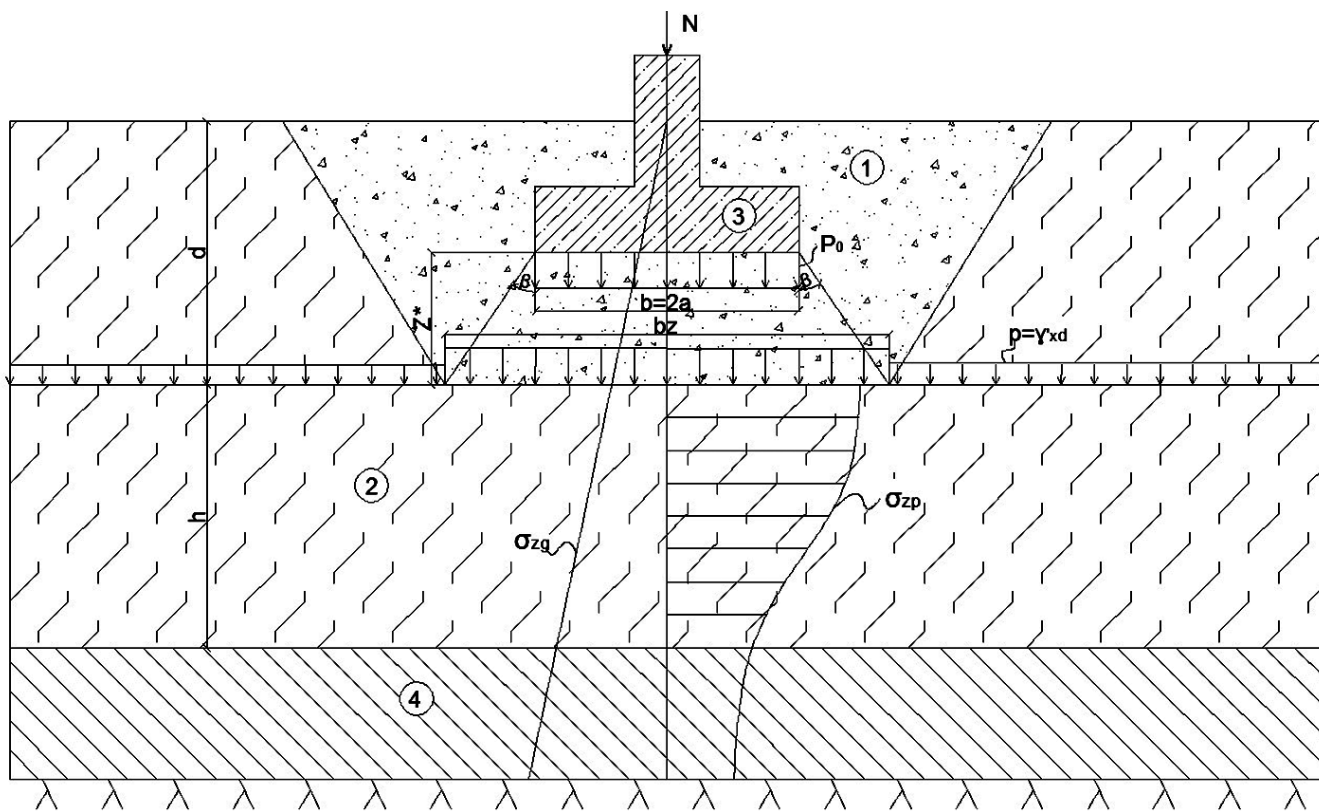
Расчетная схема грунтовой подушки (1) на слабом основании (2), вмещающая фундамент (3), подстилаемая сравнительно плотными грунтами (4): a – половина ширины фундамента; b – ширина фундамента; N – распределенная нагрузка; P_0 – распределенная нагрузка от фундамента; p – нагрузка от верхнего слоя; d – мощность сильного слоя; h – мощность слабого слоя; σ_{zp} – эпюра дополнительного давления; σ_{zg} – эпюра природного давления
